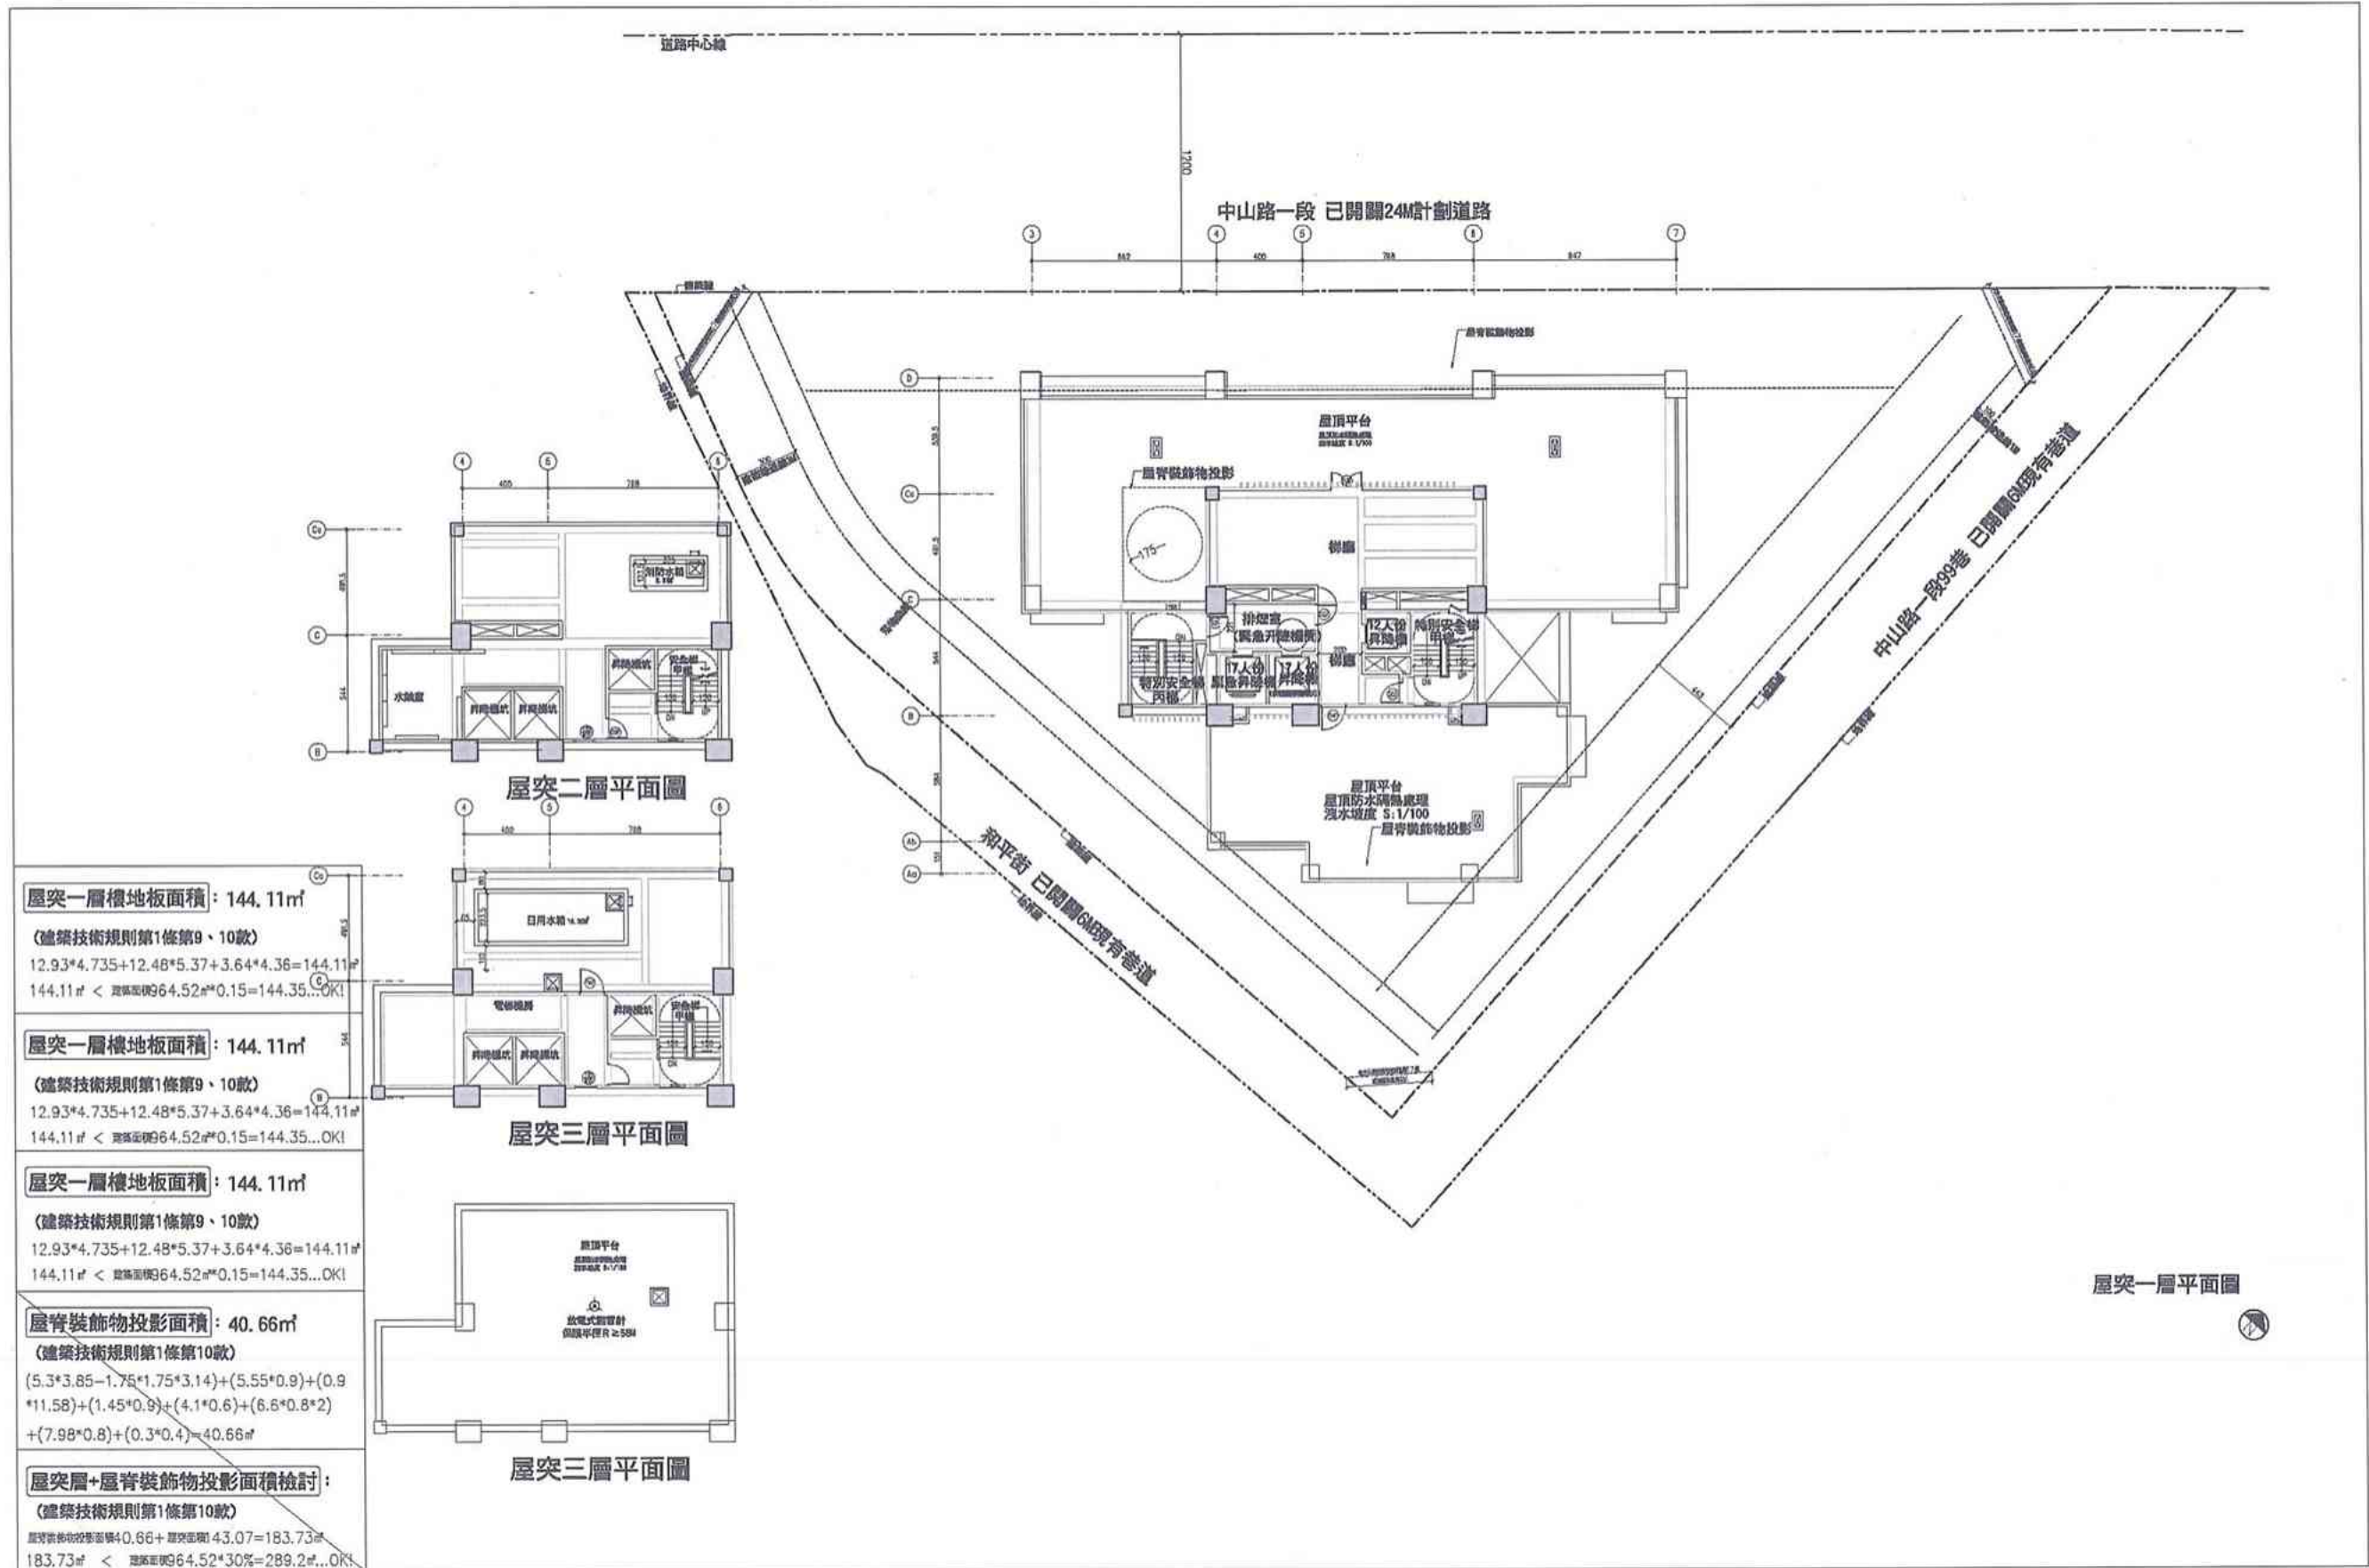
屋突各層平面圖；SCALE A3=1/300
